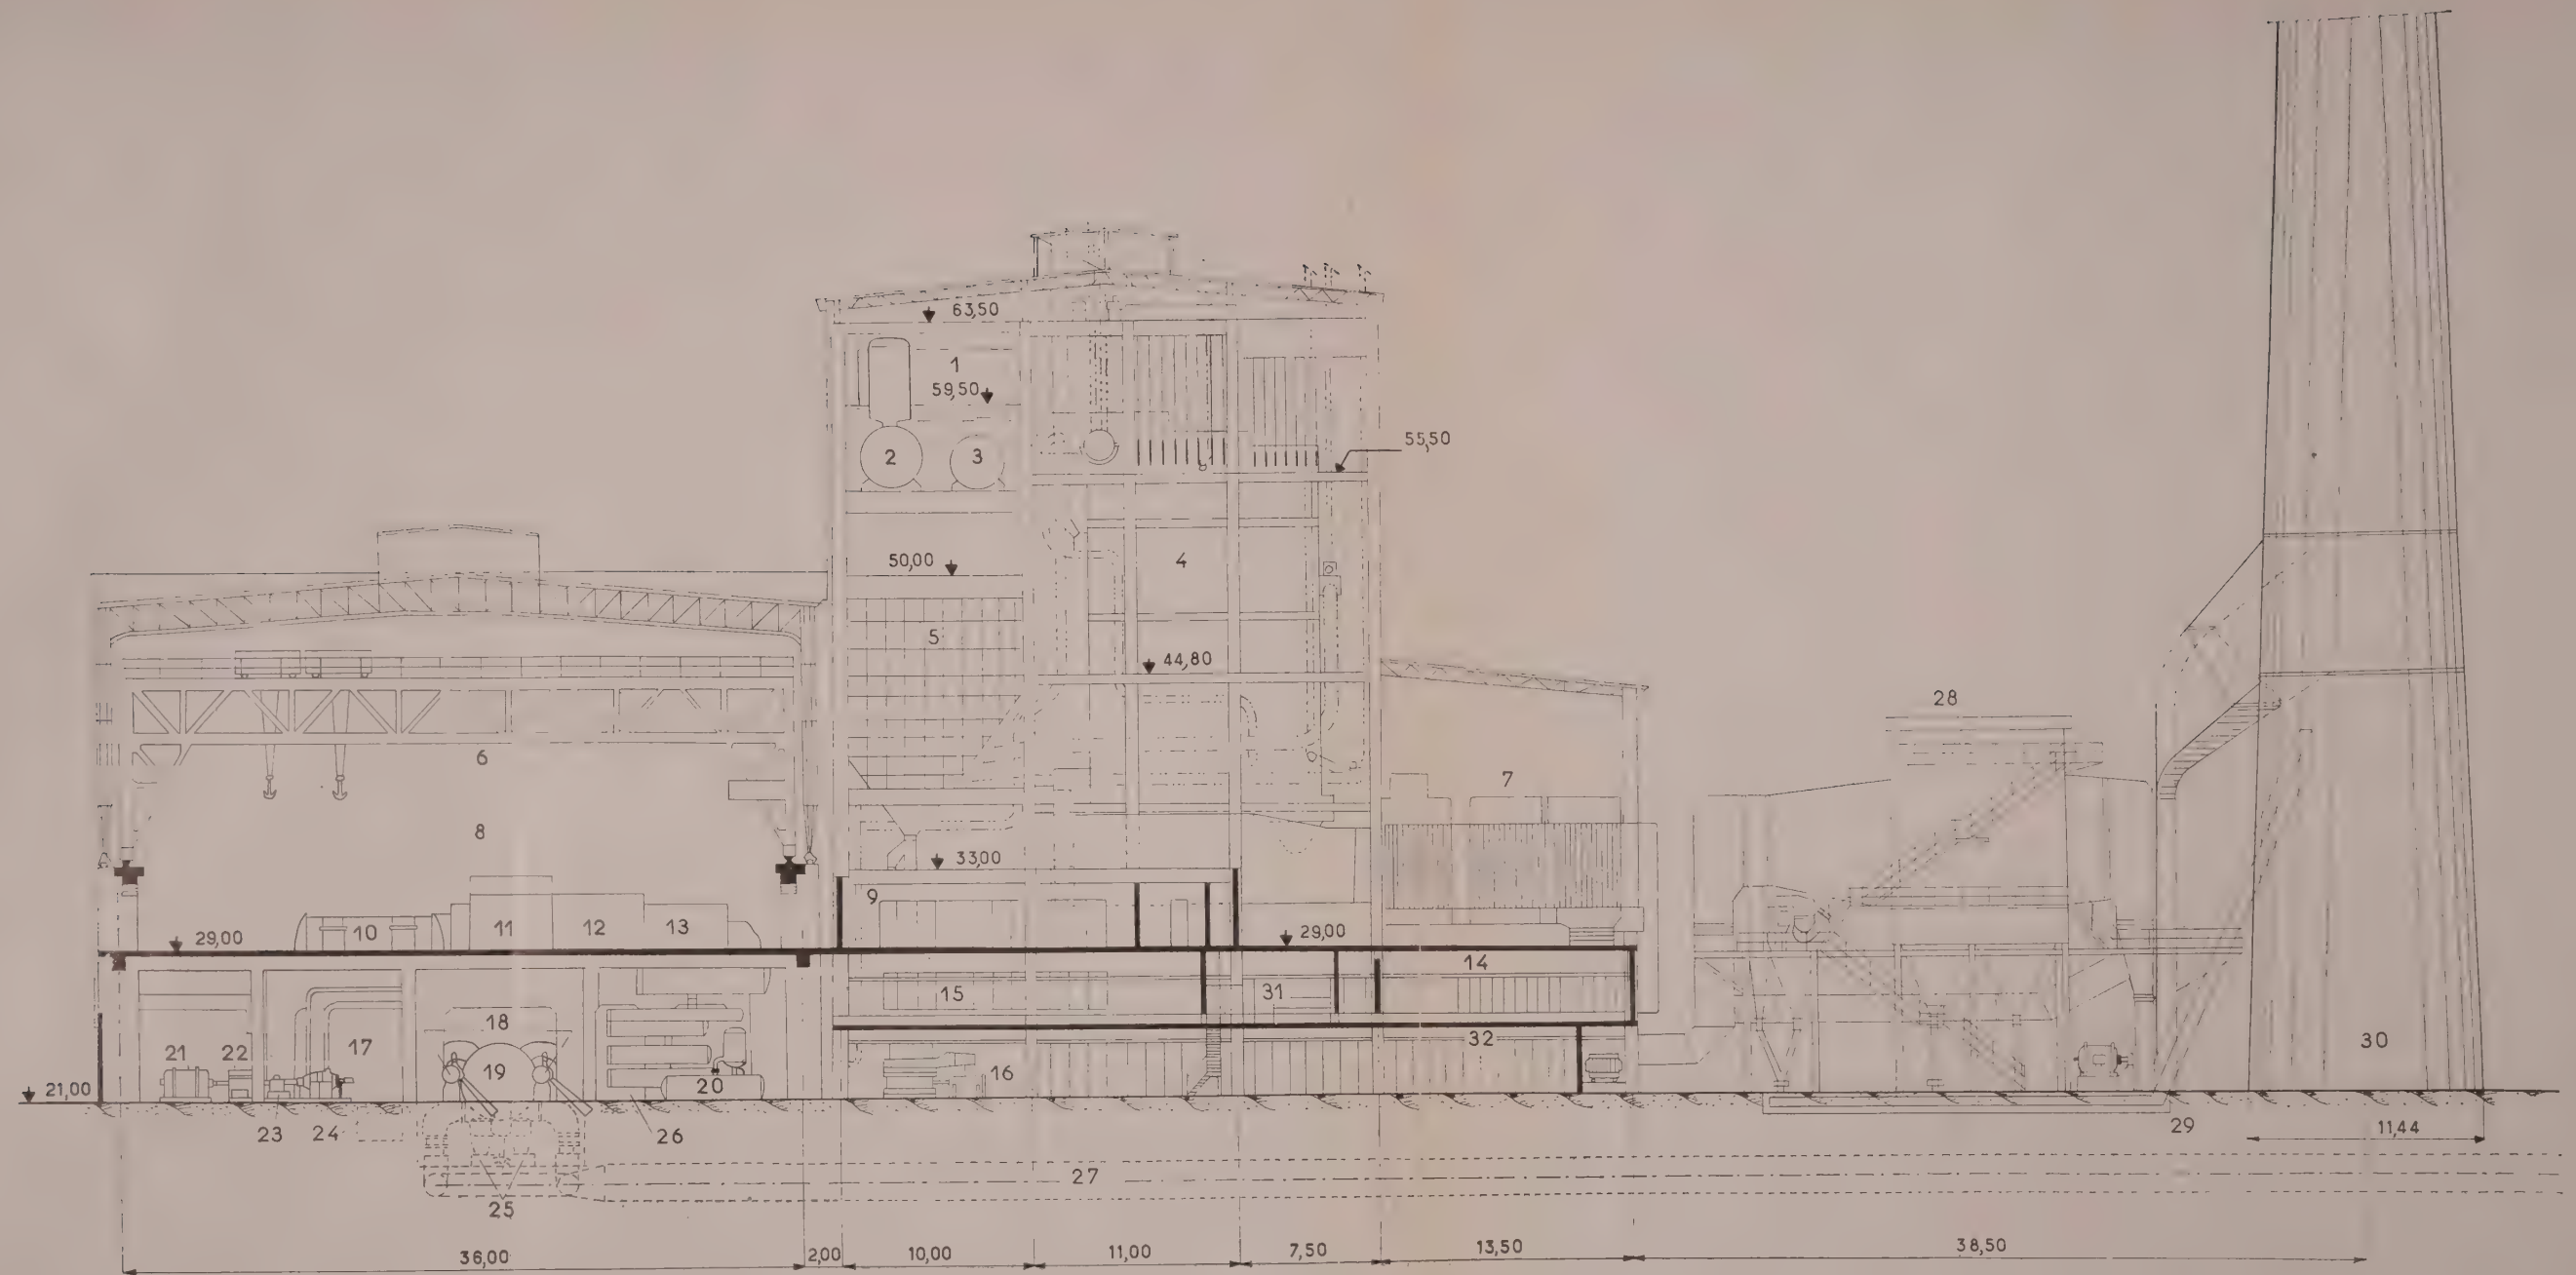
Centrale de Porcheville. Coupe transversale.
